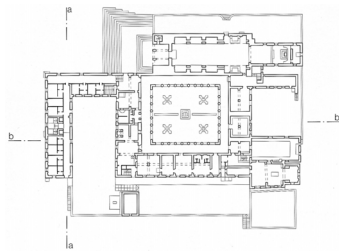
平面図 サンタ・マリア・ド・ボウロ
